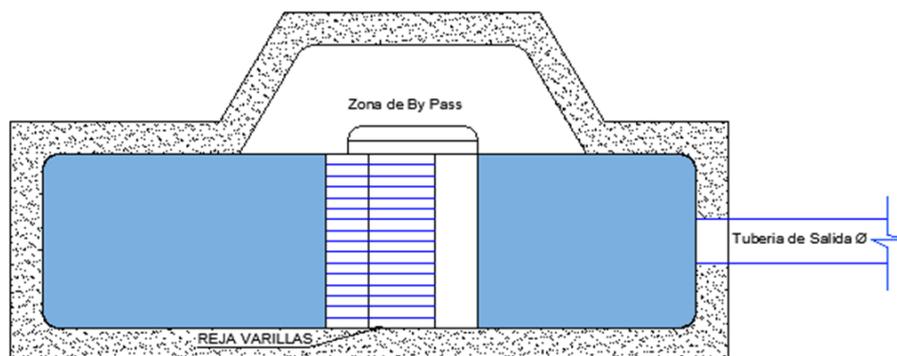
Planta de la cámara de Rejas (elaboración: Propio)
